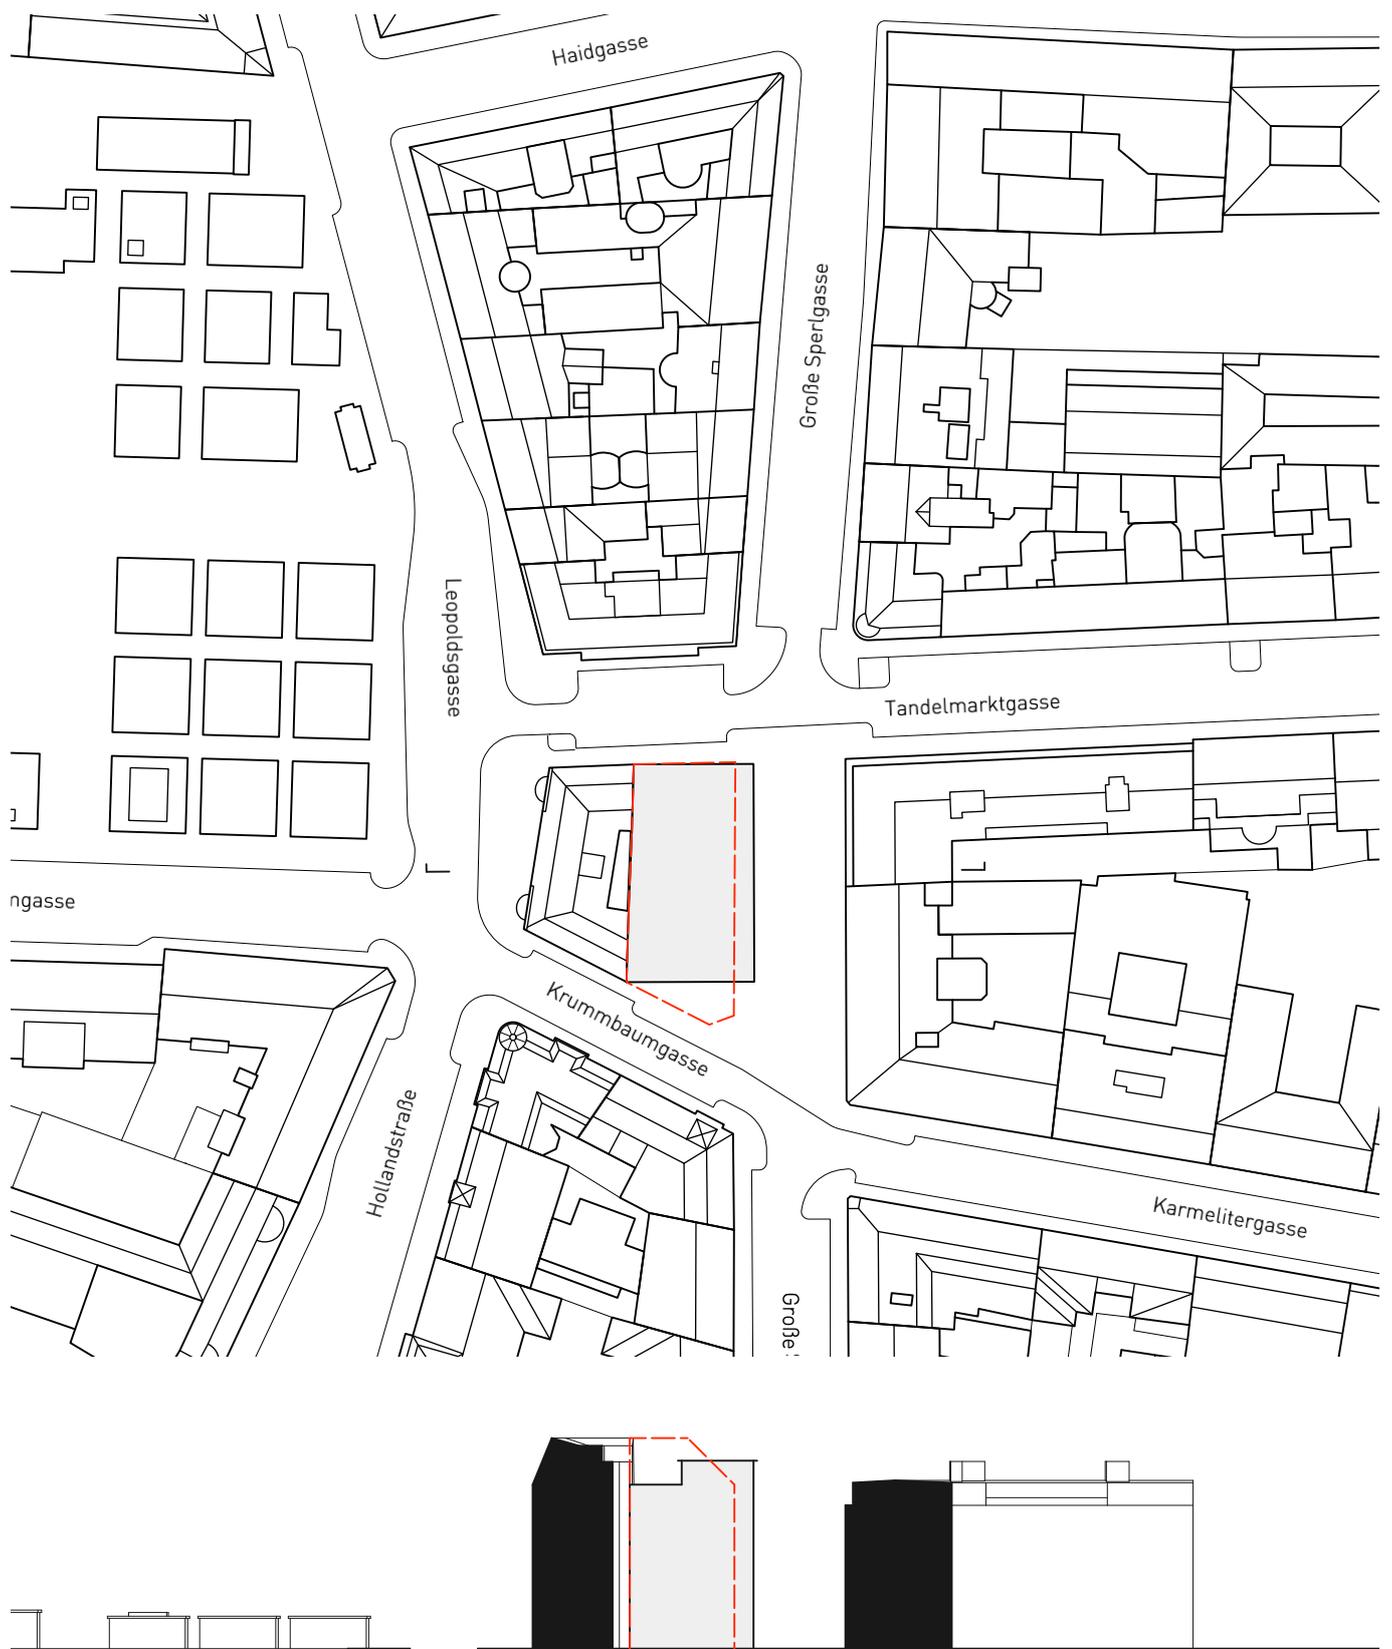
Lageplan und Schnitt mit neuem Grundstückszuschnitt 1:1000 (BM)
